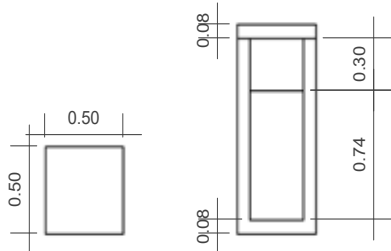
Planta e elevação - Lixeira. Fonte: produzido pela autora, 2018.
